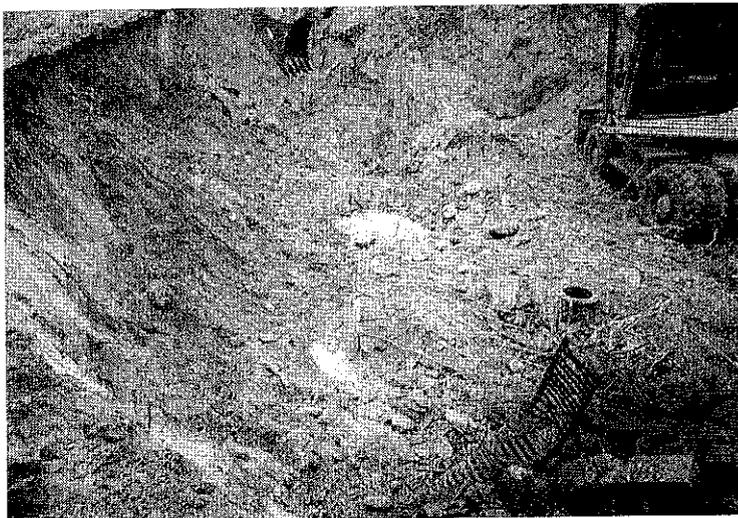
Rückbau Betonwänden LFA bis Grundplatte, ca. 4,5 m unter Geländeoberkante
